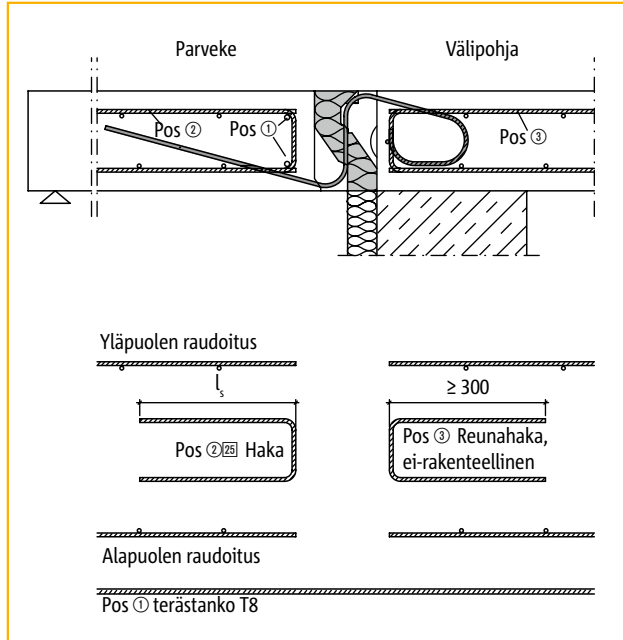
Leikkaus, elementtiparvelaatta, Schöck Isokorb® V6/6-H160
